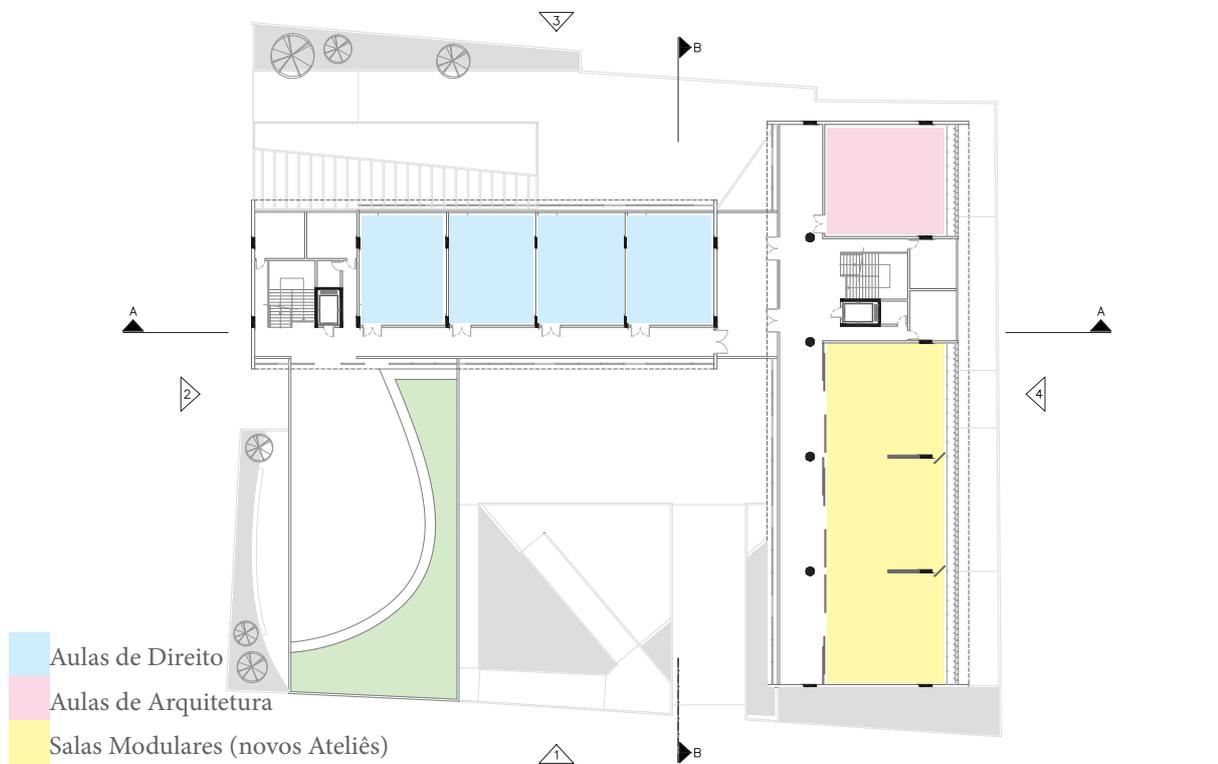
Nova proposta para o primeiro pavimento de Salas de Aula modulares para Arquitetura
